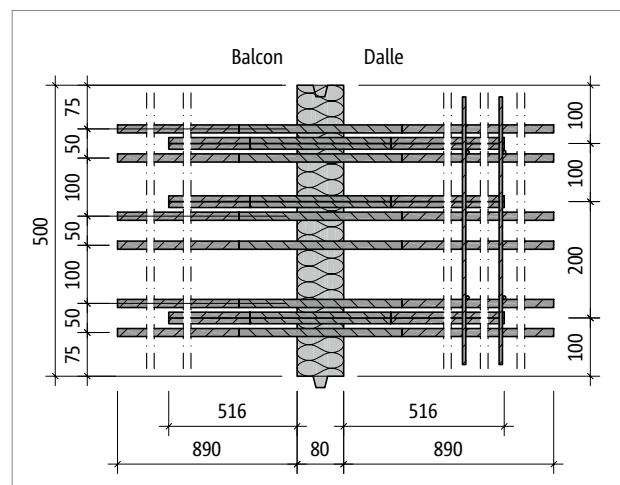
Schöck Isokorb® T type D-MM6-VV3 : plan de base
